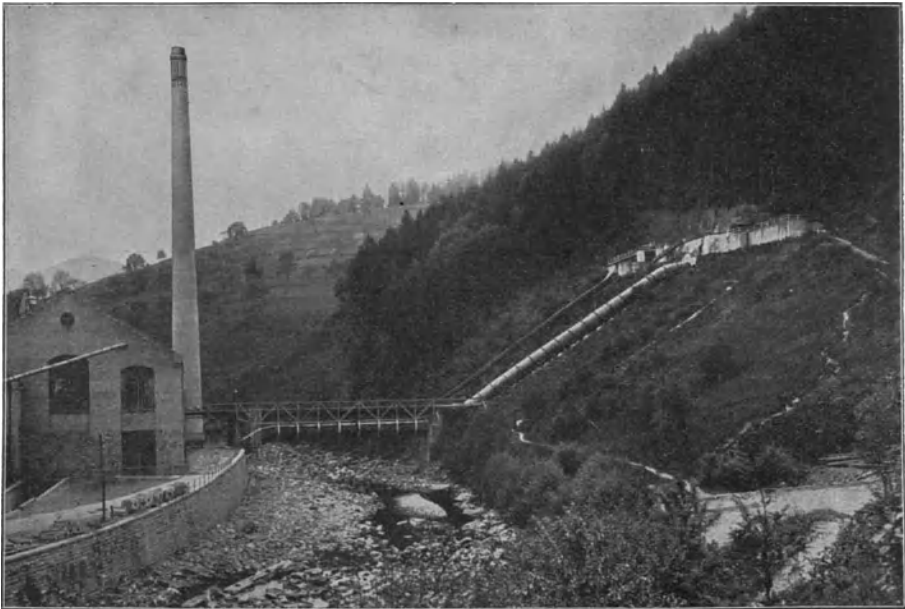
Hochgefälle-Turbinenanlage der Holzstoff- und Papierfabrik Wolfscheck. Rechts Wasserschloß und Druckrohrleitung, links Fabrikanlage.
